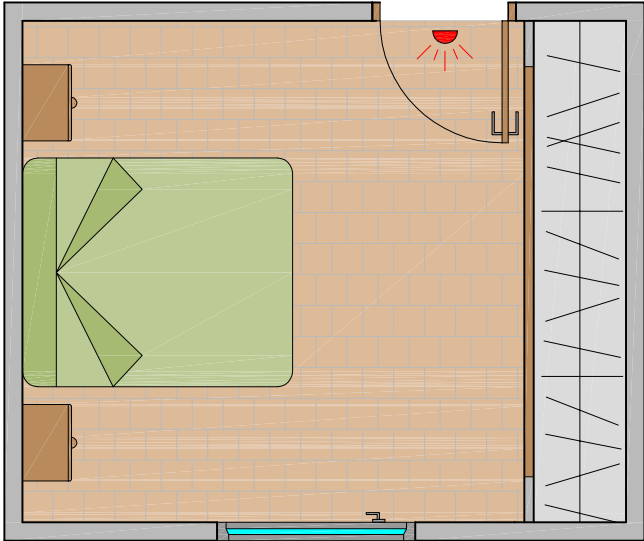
Vista en planta de un dormitorio de matrimonio accesible.
